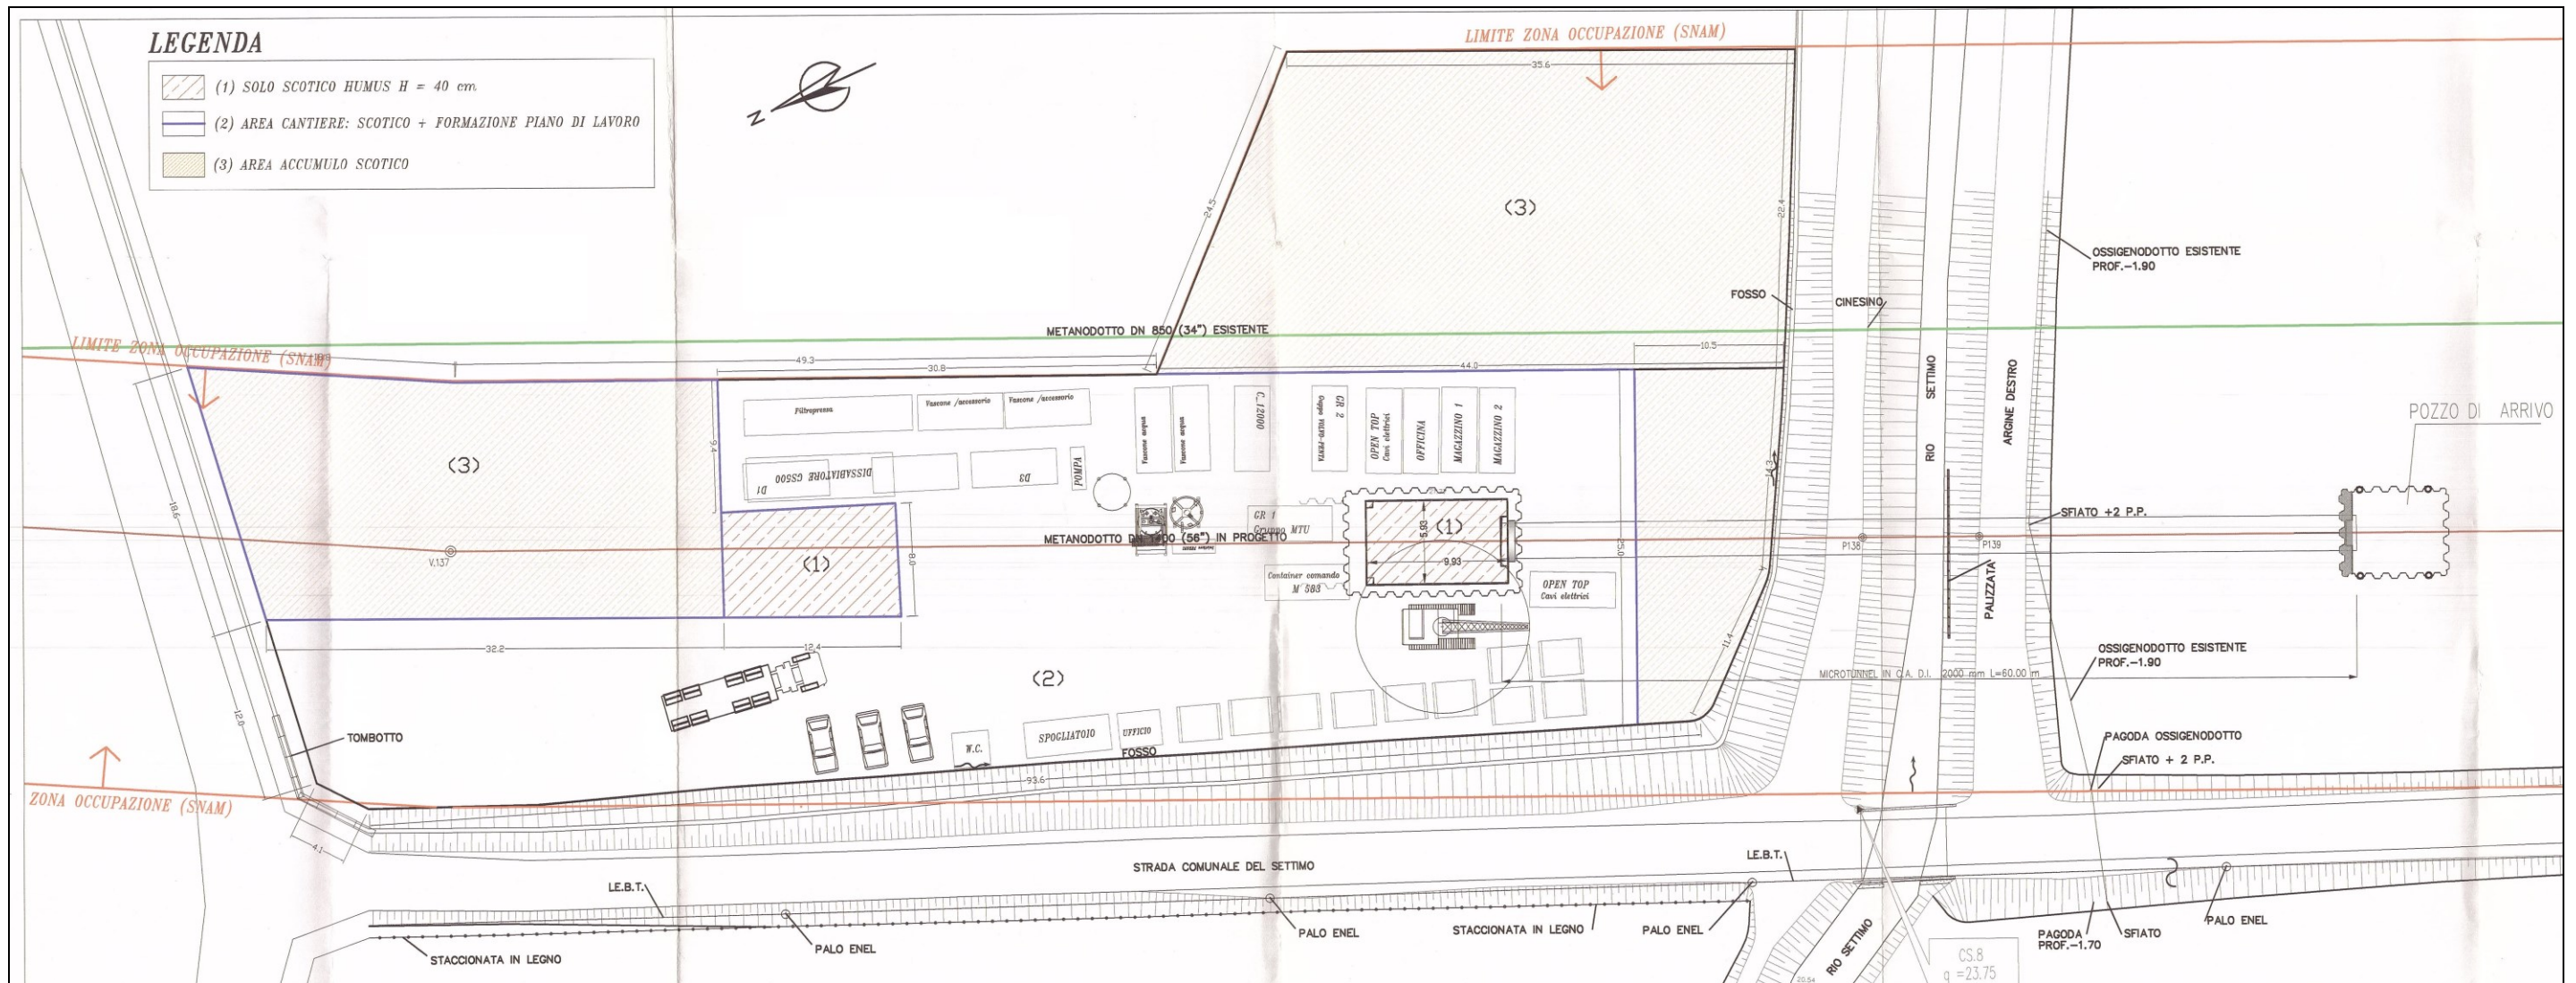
/E: Planimetria cantiere microtunnel - Esempio
